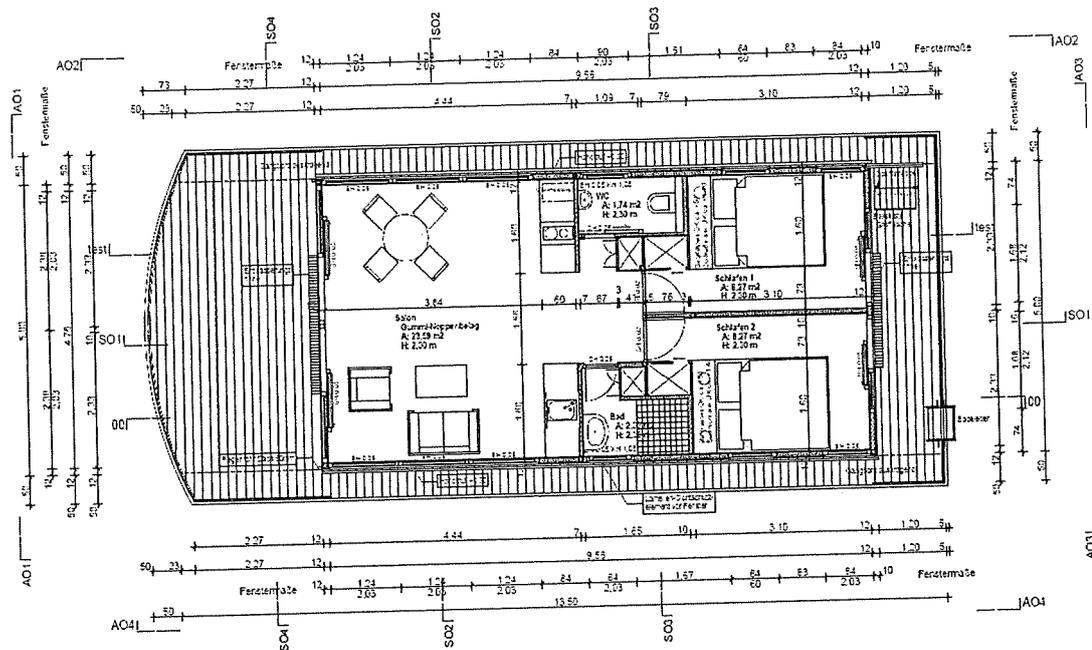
Grundriss des Hausbootstyp FL 44
